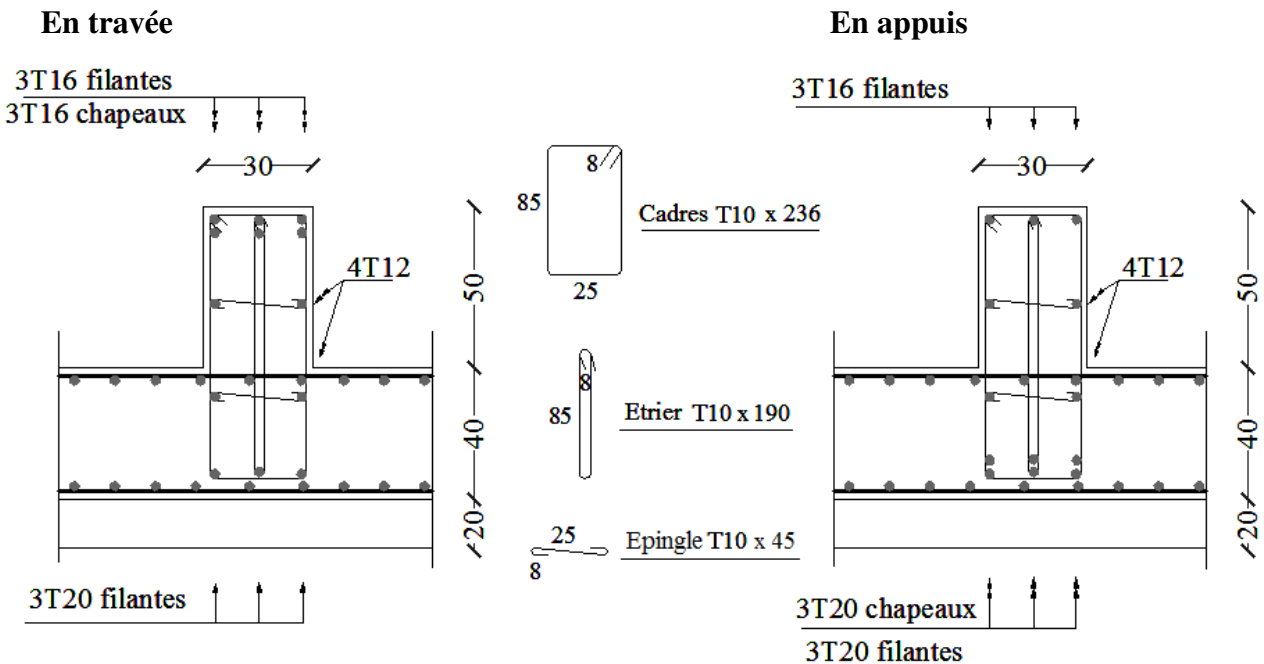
Schéma de ferrailage des poutres secondaires
